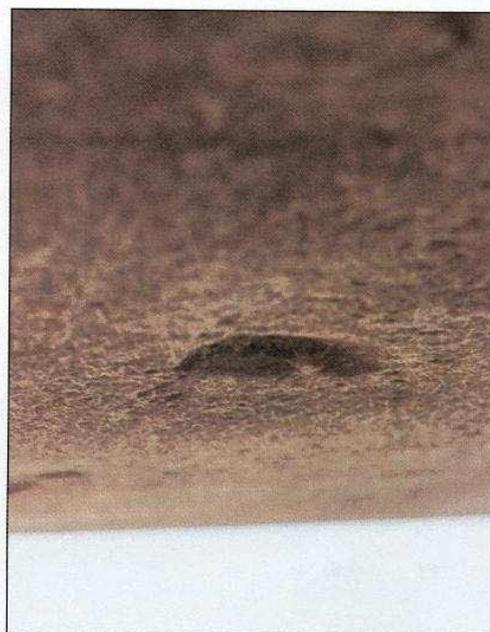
surface lisse signe d'un délaminage de la couche dure
